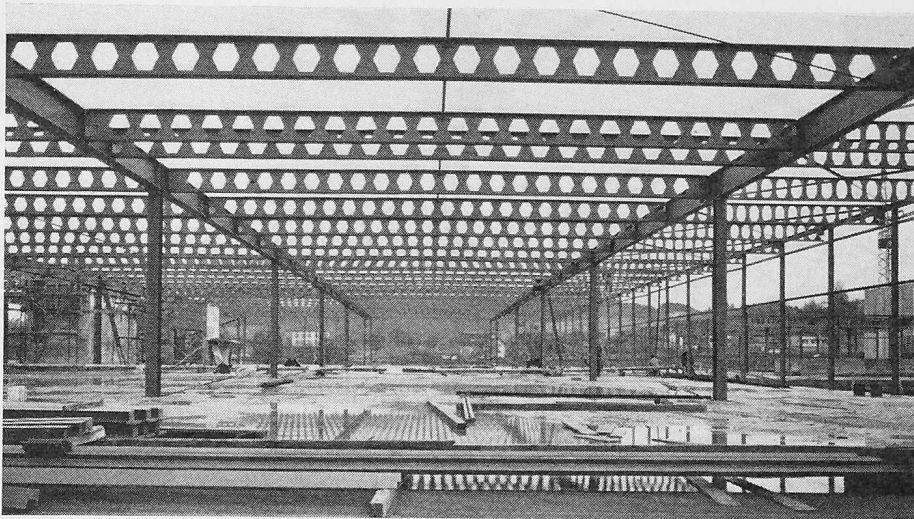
Wabenträger als weitgespannte Dachpfetten. Genossenschaft Migros St. Gallen, Betriebs-zentrale in Gossau
